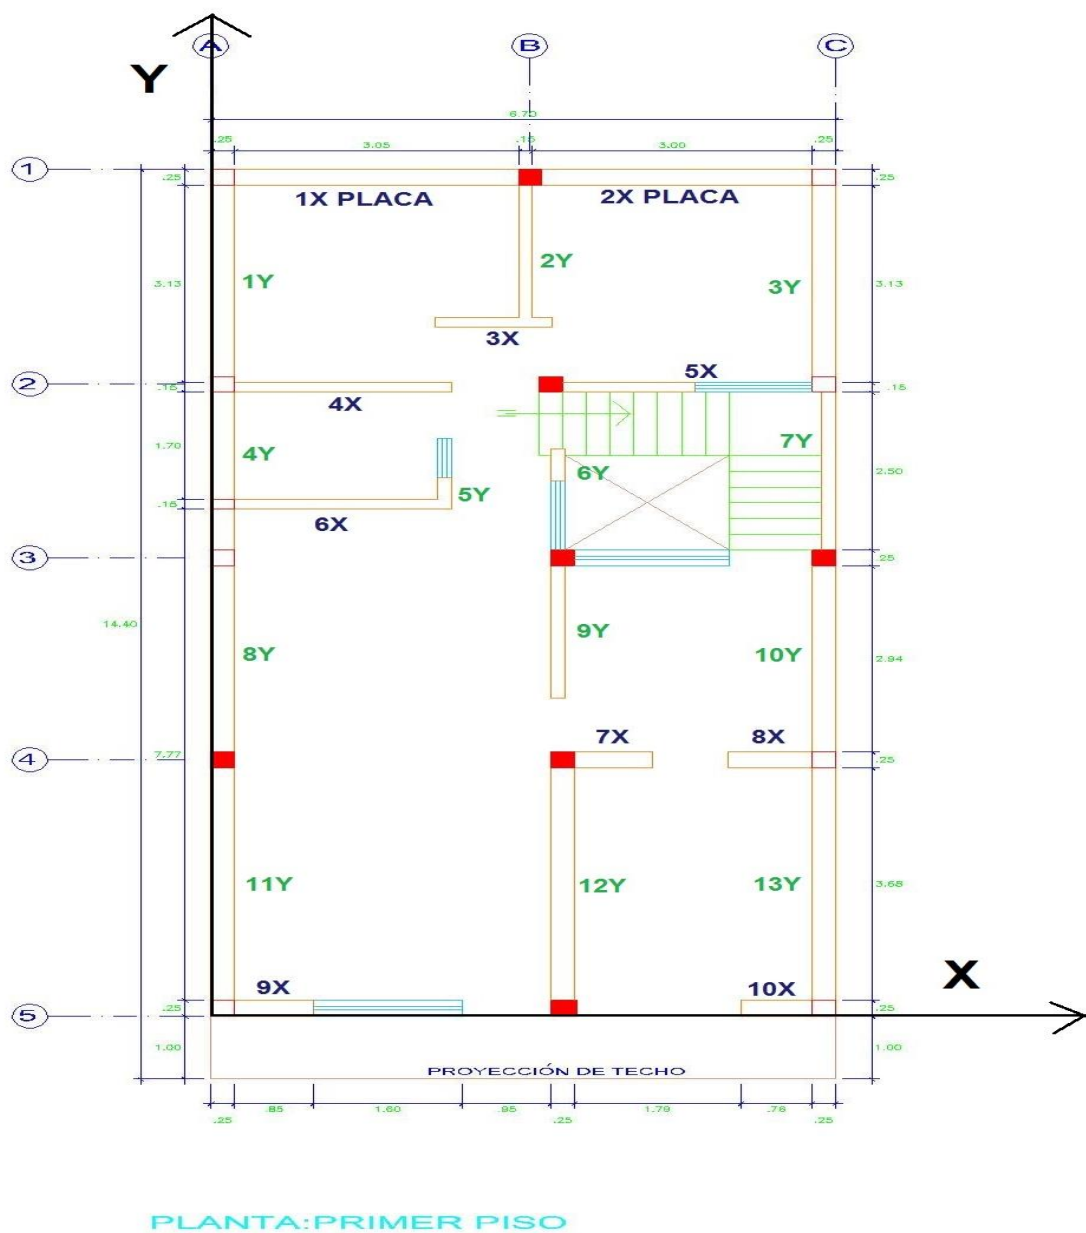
Enumeración de muros en vista en planta del primer piso - Lote 39 (Fuente: Elaboración Propia)
